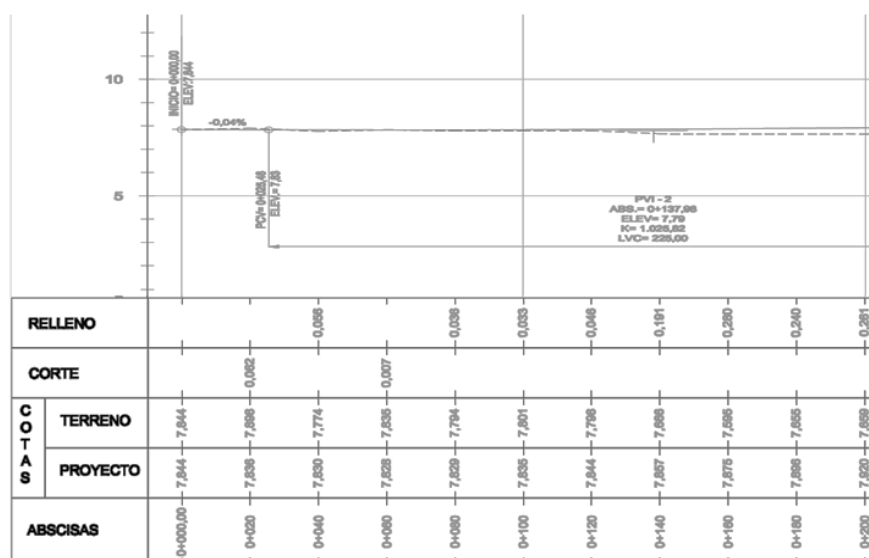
vista del perfil longitudinal de la vía (0+000-0+200)
